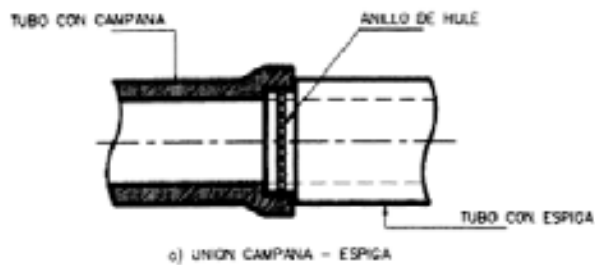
Uniones espiga-campana en tubería de concreto simple y reforzado.
